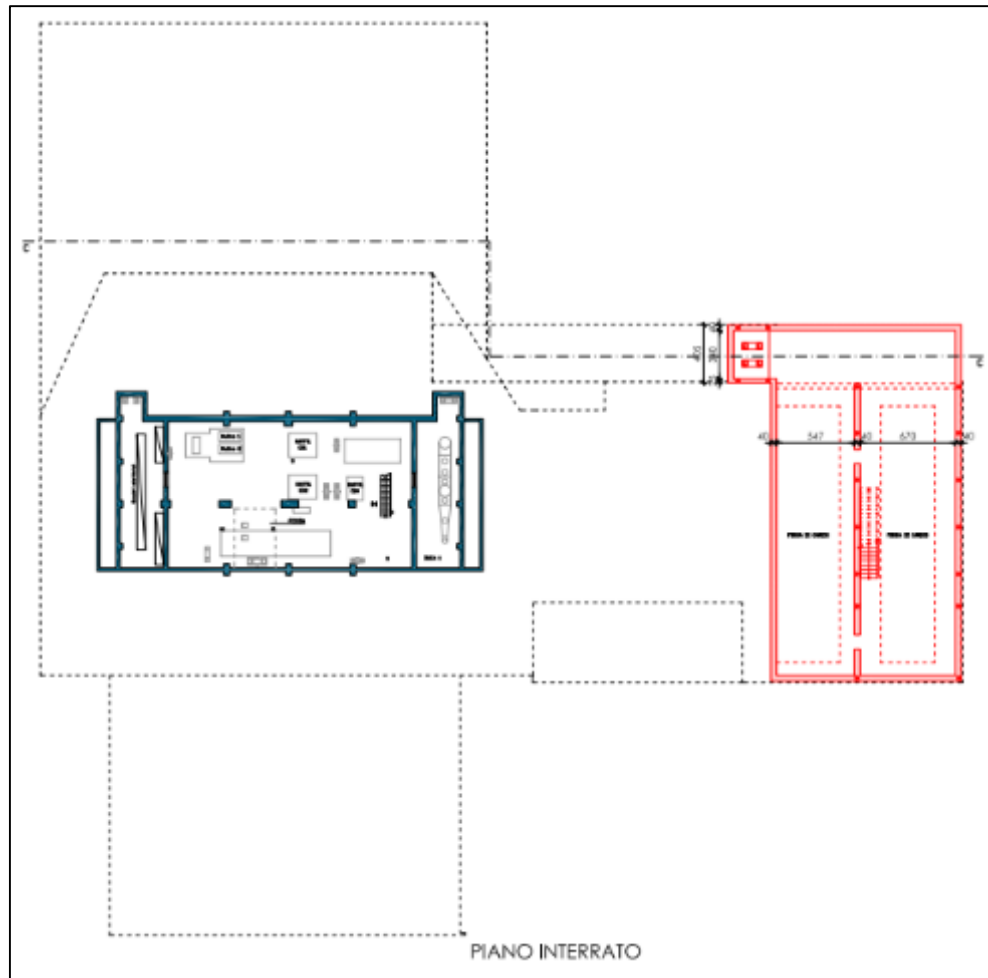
Pianta piano interrato - sovrapposizione con stato di progetto
